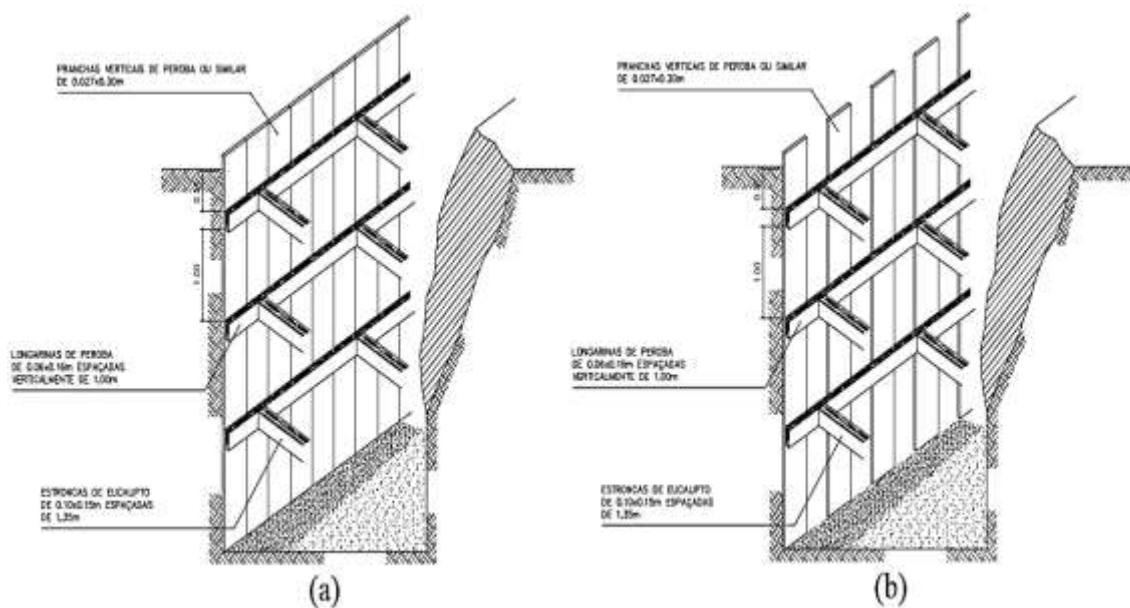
Detalhe construtivo para escoramento apresentado no projeto executivo.
